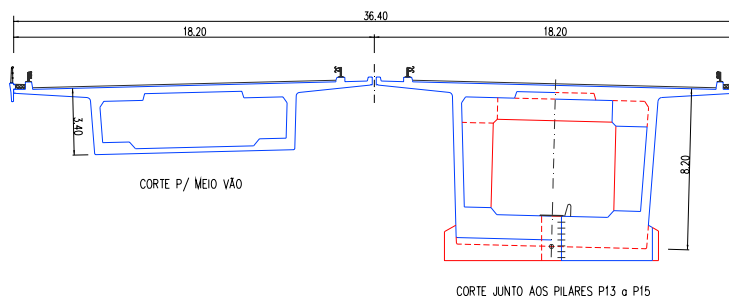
Secção transversal dos tabuleiros em viga caixão.
